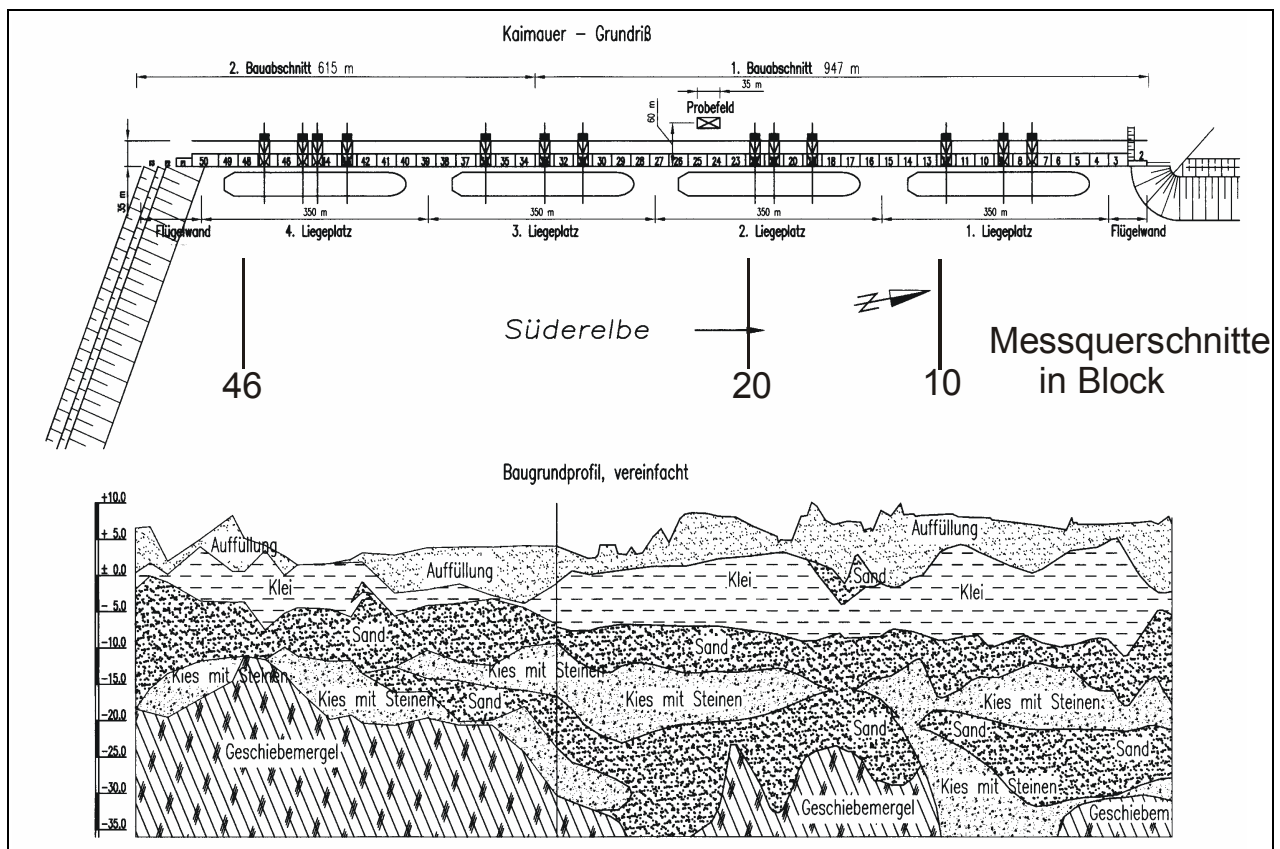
Überblick Kaimauergrundriss und Baugrundprofil [LINDER et al., 2003]
